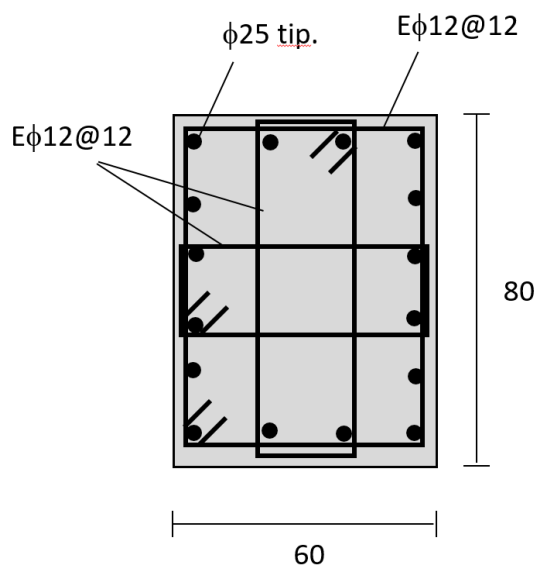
Sección transversal del elemento (Hube, 2022a)
